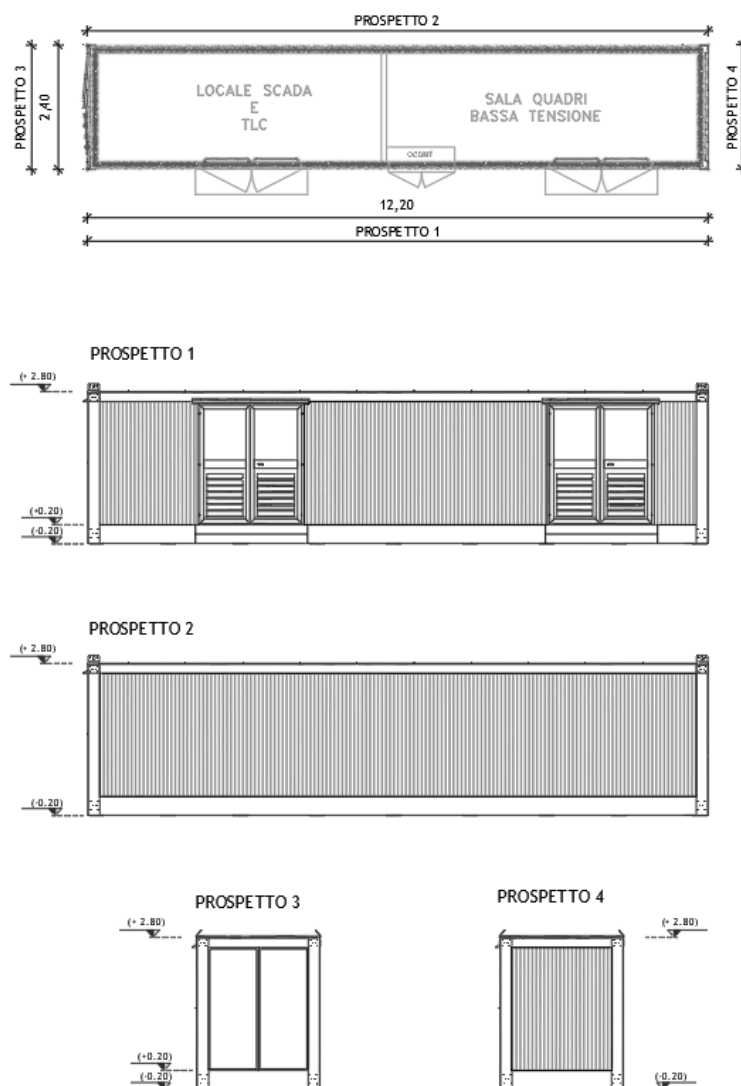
Pianta e prospetti dell'edificio B.T. + SCADA e TLC
